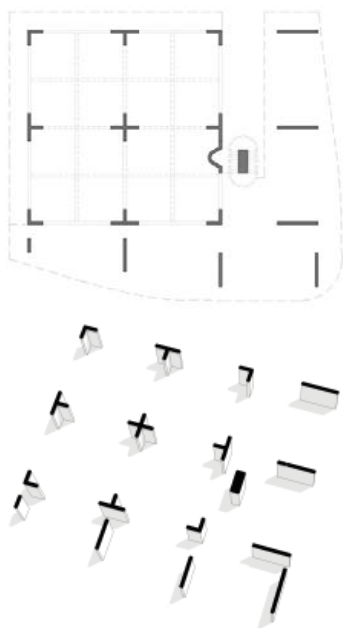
Planta e Isometría de la estructura de la segunda versión. Fuente: MCHS.
